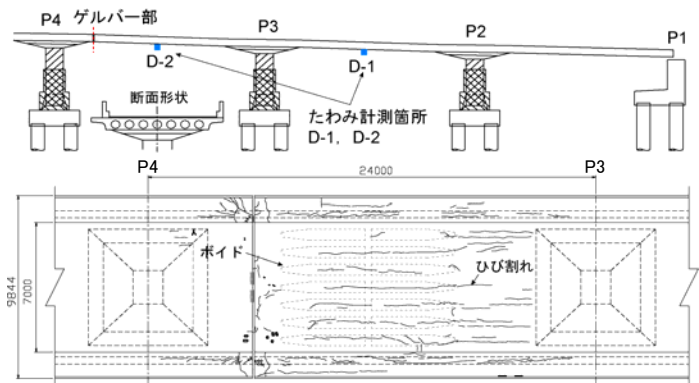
橋梁一般図および床版下面のひび割れ状況
